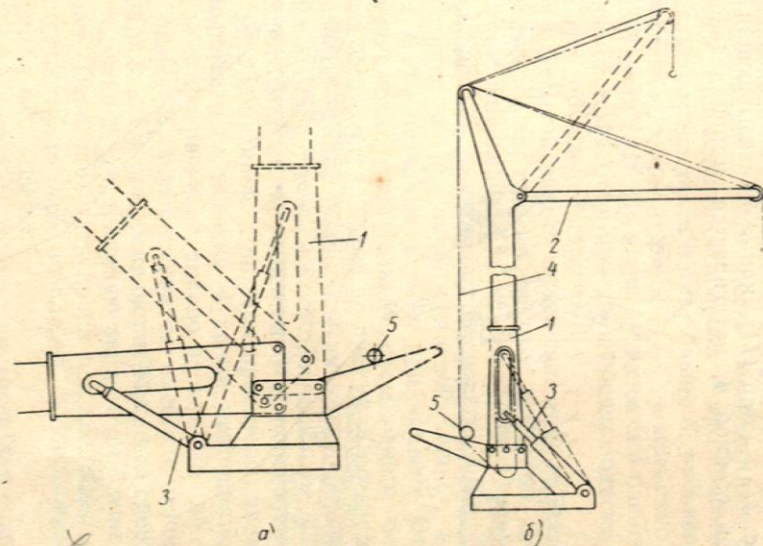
Схема подъема башни и стрелы гидроцилиндром:
